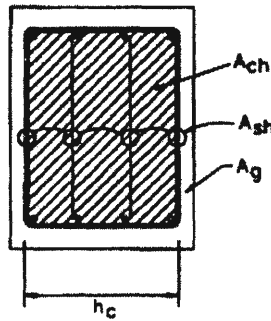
Parámetros para la determinación del área de refuerzo transversal de confinamiento en columnas
